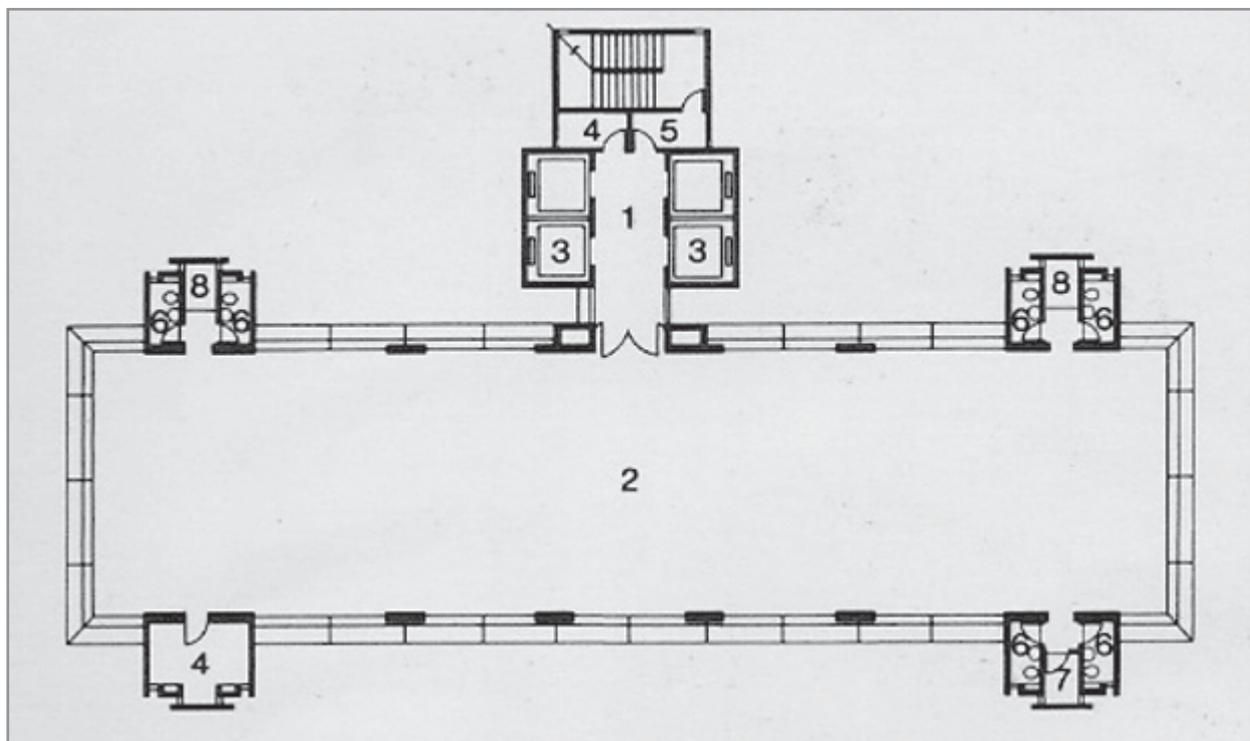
Planta do pavimento tipo - Fonte: Revista Projeto nº 110, Maio de 1988, página 91.
